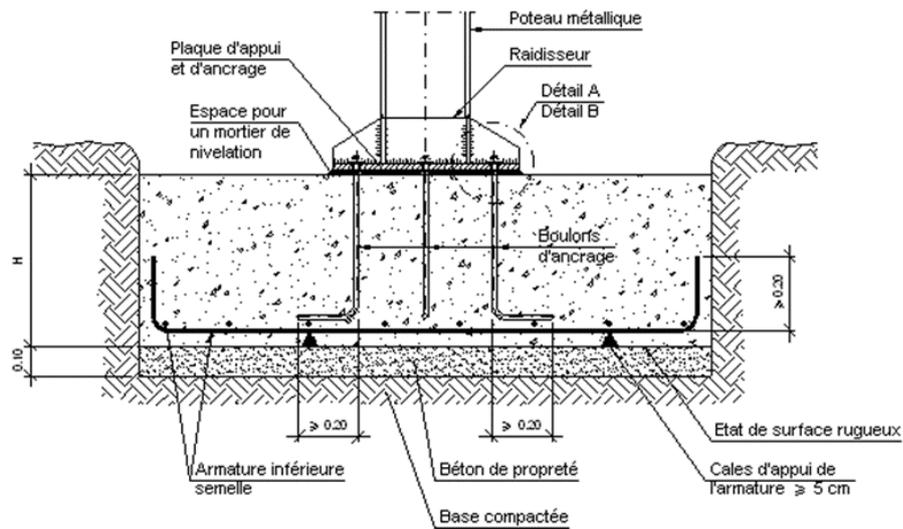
Base, en fondation, de poteau (HEA). Union rigide.
